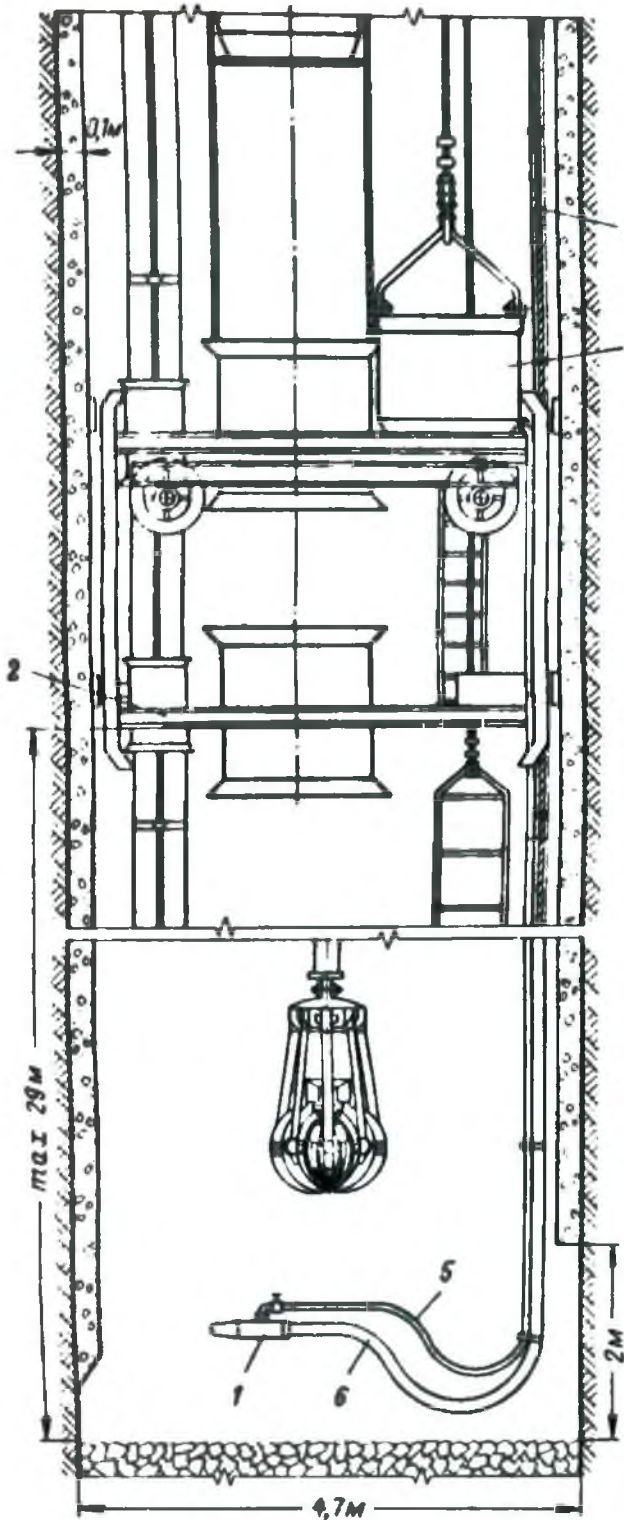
Схема расположения проходческого оборудования в стволе при креплении набрызгбетоном:
